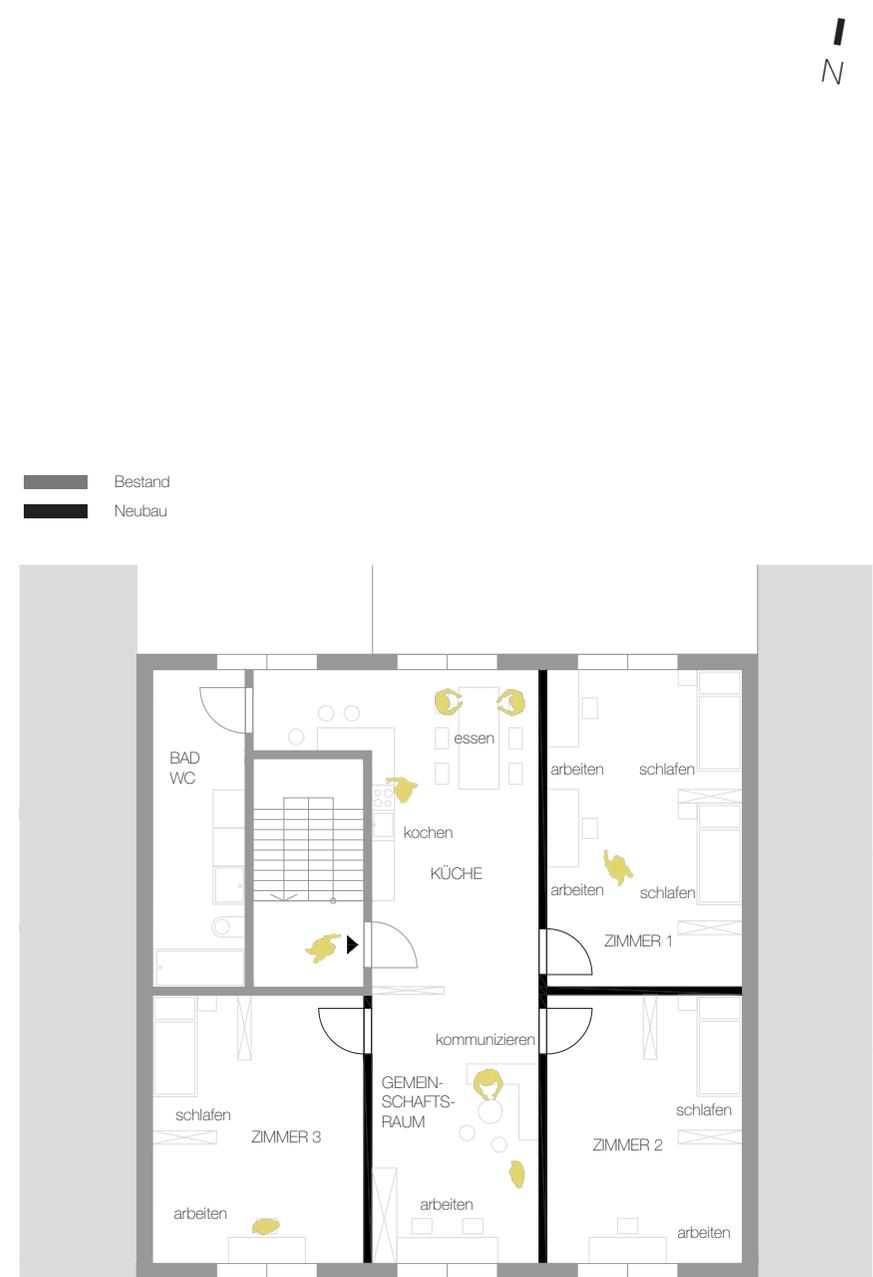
Grundriss OG 1 (Szenario1)
